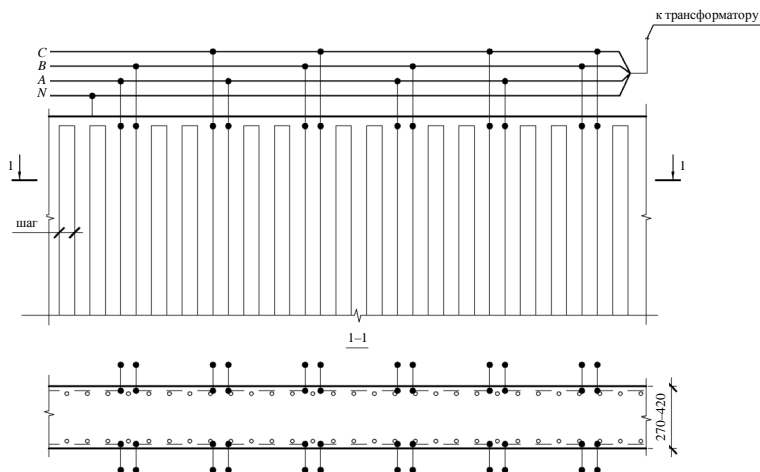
Принципиальная схема укладки греющих проводов при периферийном электропрогреве плиты перекрытия
